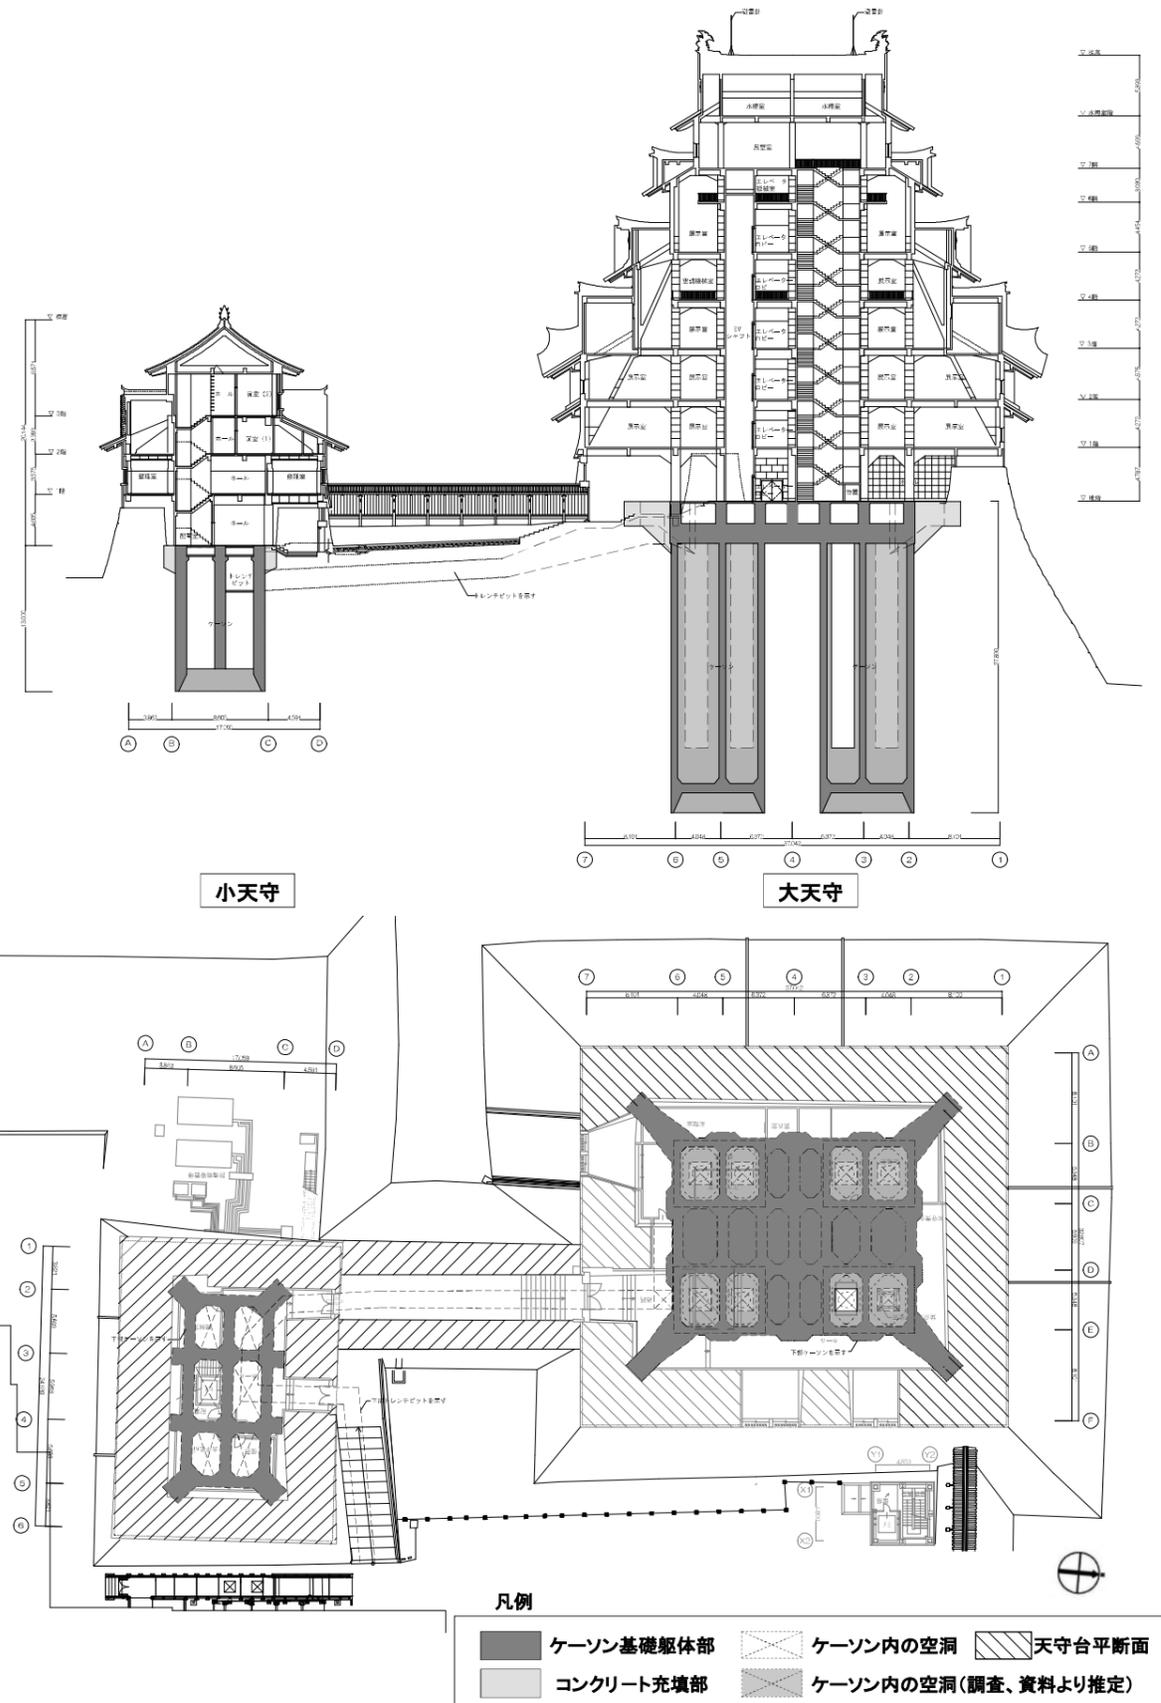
現天守閣ケーソン基礎平面図・断面図
